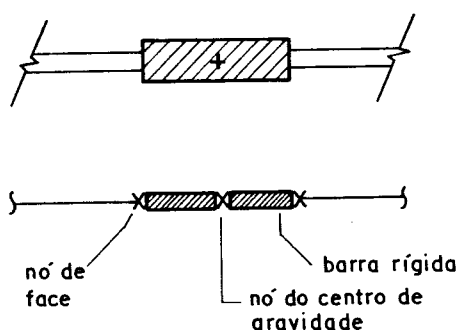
Trechos horizontais rígidos em pilares
